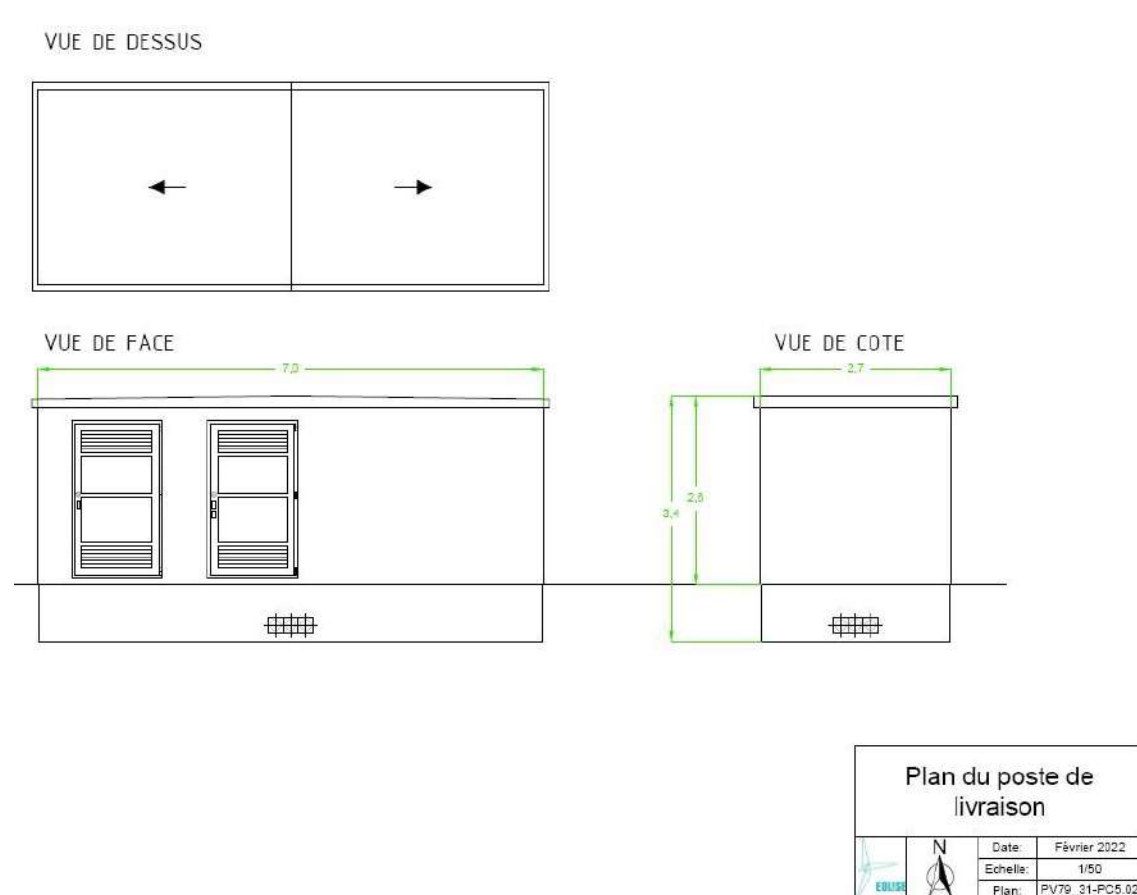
Plan technique d'un poste de livraison (source : EOLISE)
